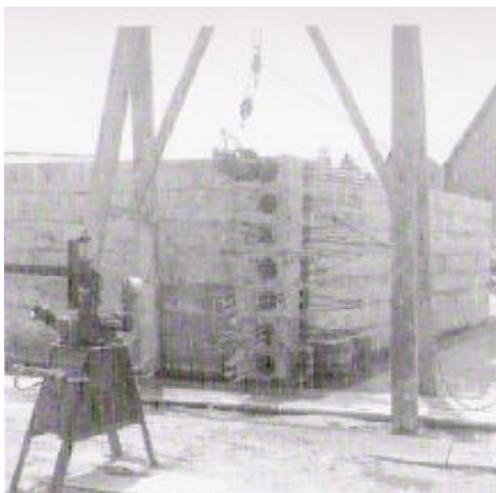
Peças pré-fabricadas separadas por papel parafinado.
